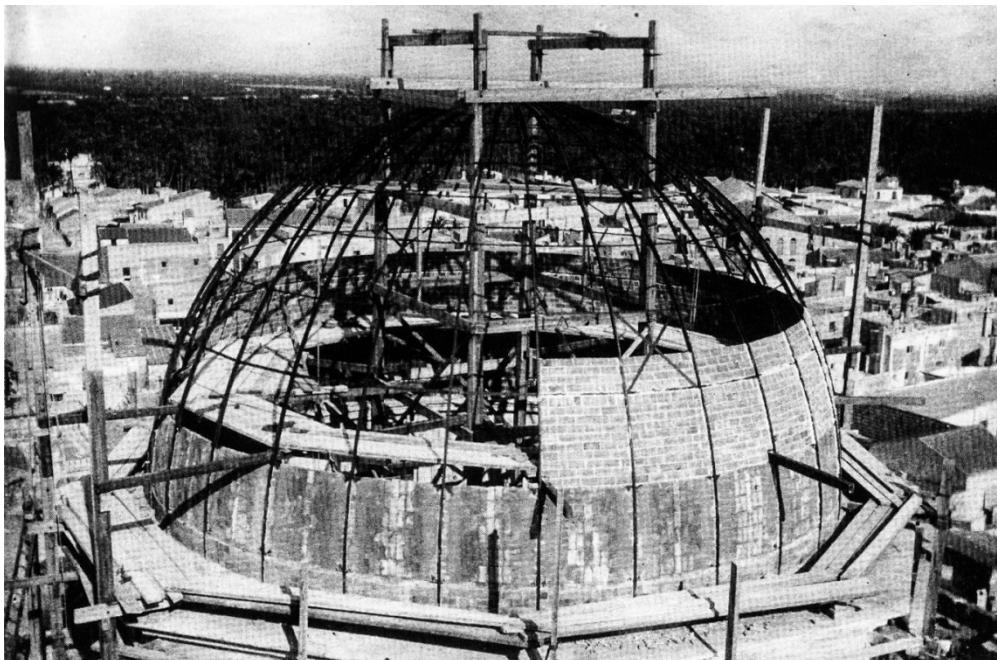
Construcción de la nueva cúpula (Ajuntament d'Elx, 2010).
